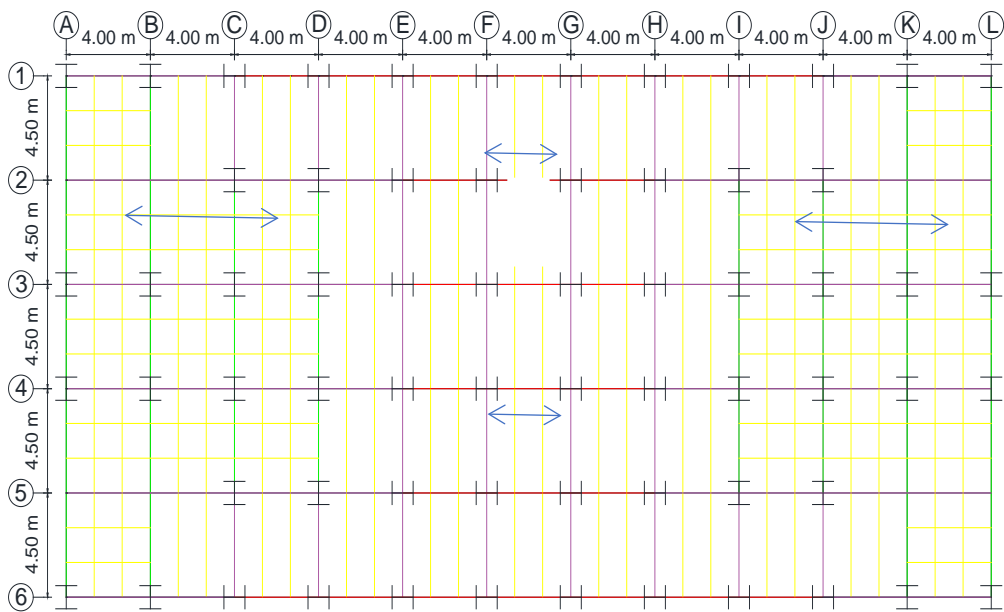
Planta de entrepiso de la edificación híbrida con panel Vierendeel 2m.
